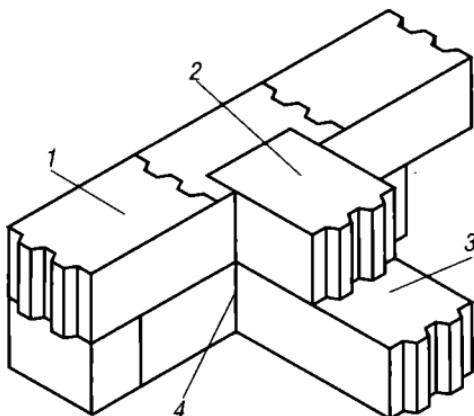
Сопряжение однослоиной наружной стены с внутренней стеной:
